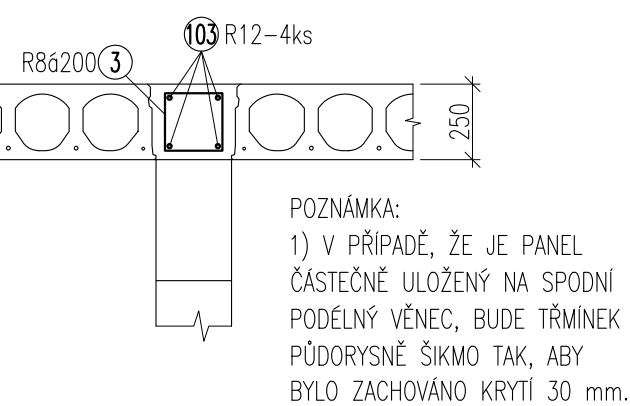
DETAIL PROVÁZÁNÍ KOLMÝCH VĚNCŮ A PRŮVLAKŮ
